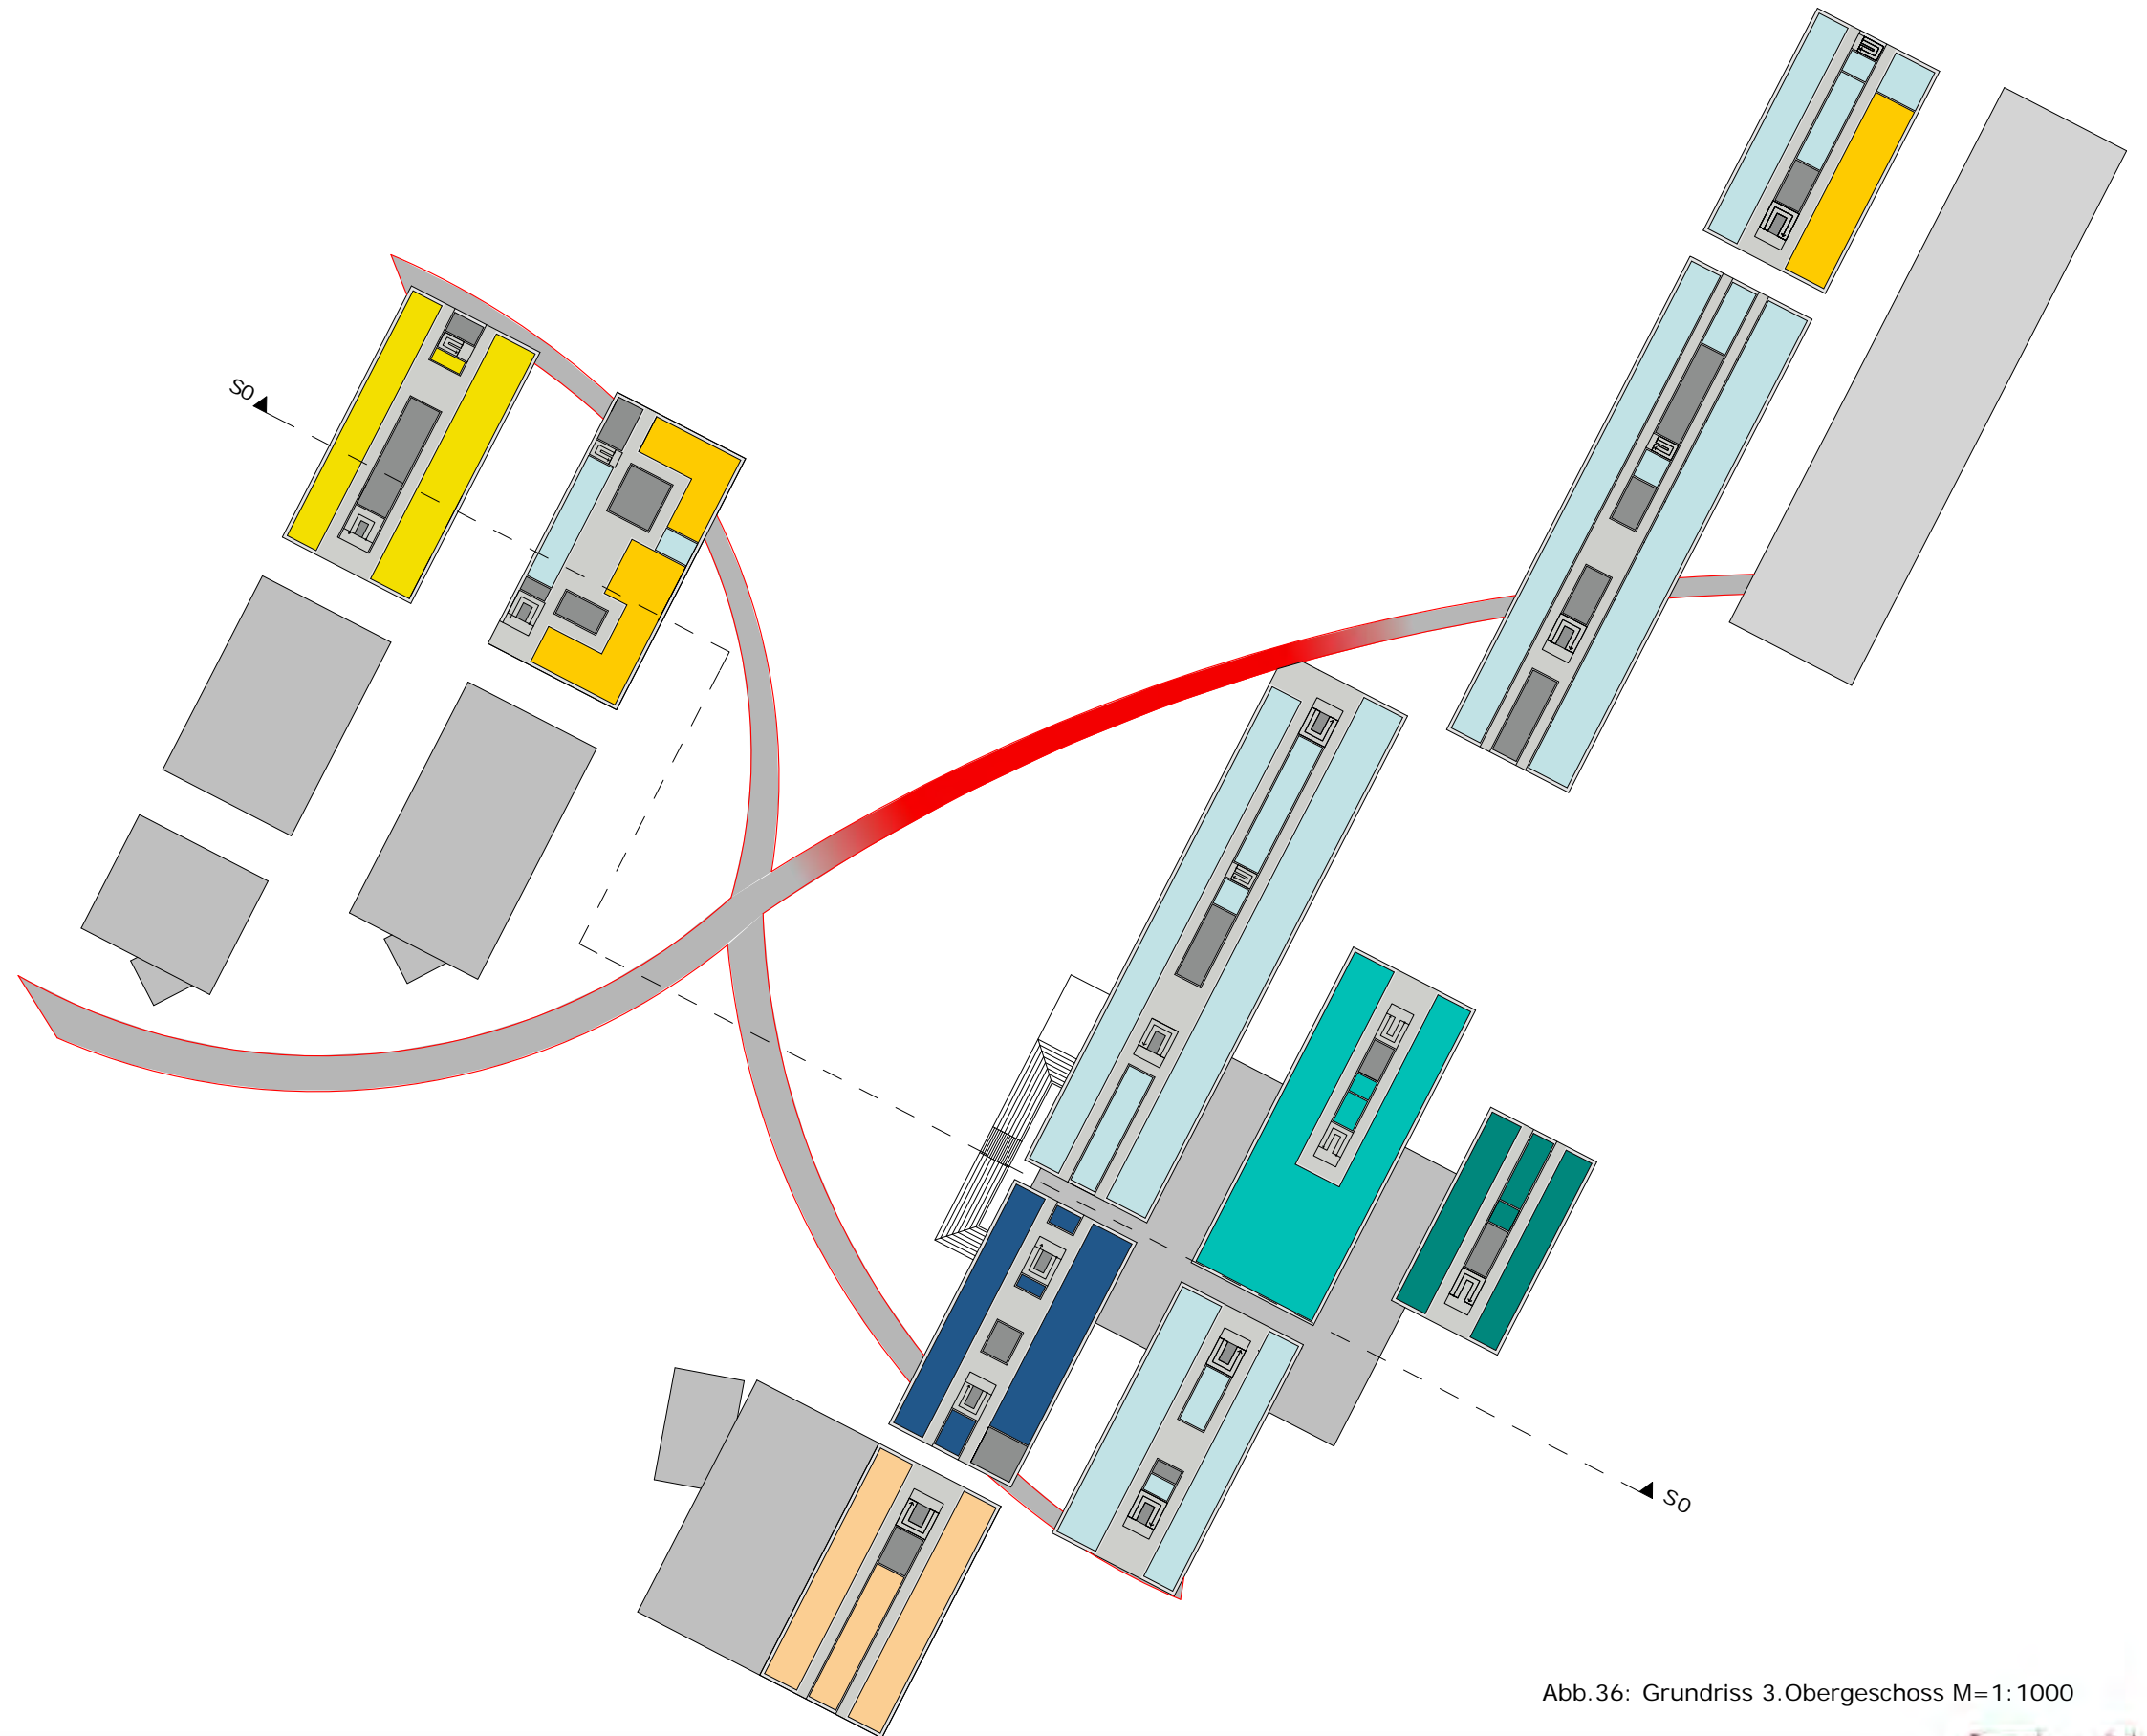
Grundriss 3.Obergeschoss M=1:1000
